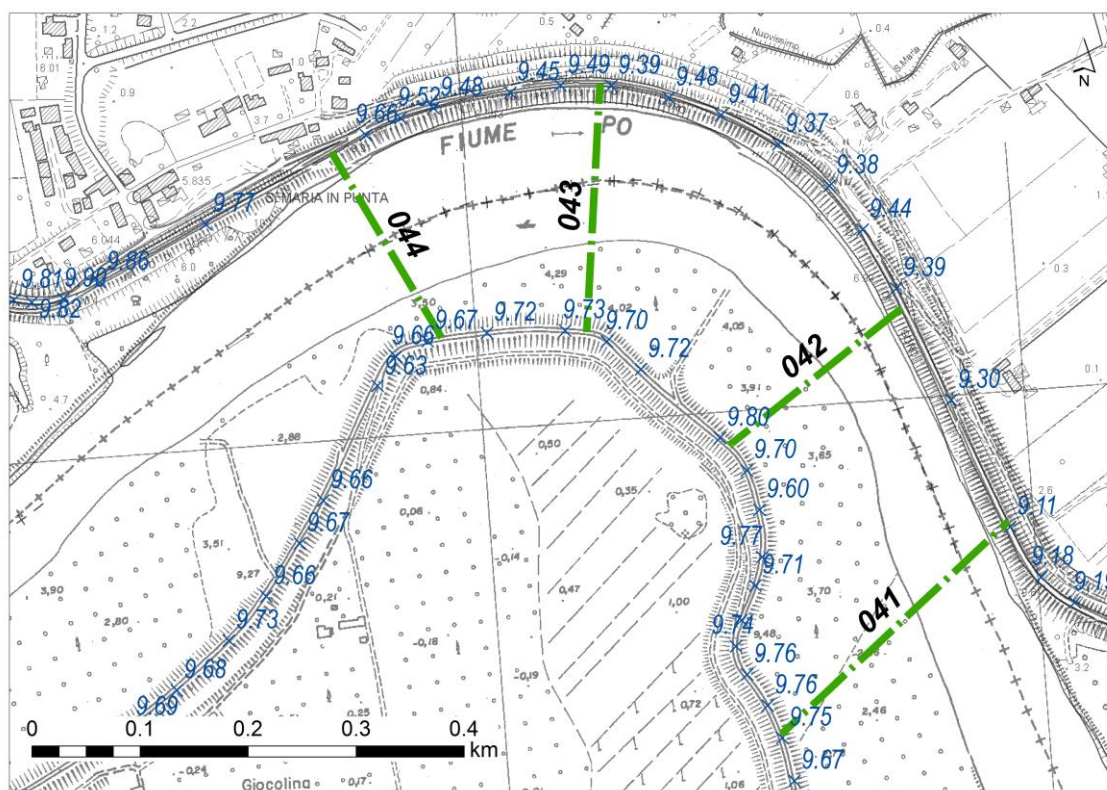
planimetria ambito di intervento con indicazione delle sezioni del Po di Goro
